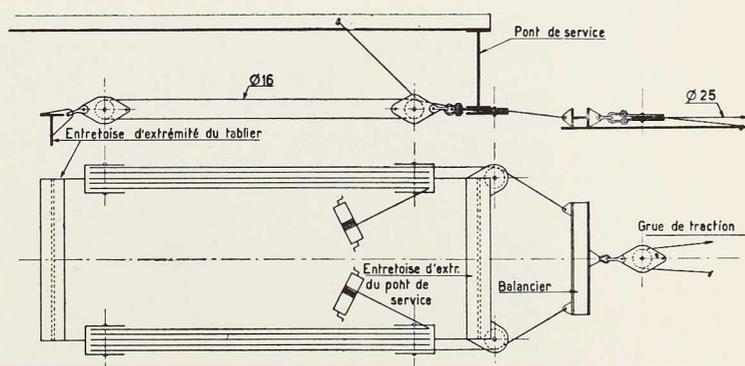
Elévation et plan des câbles de traction pour le lançage du pont de service.
